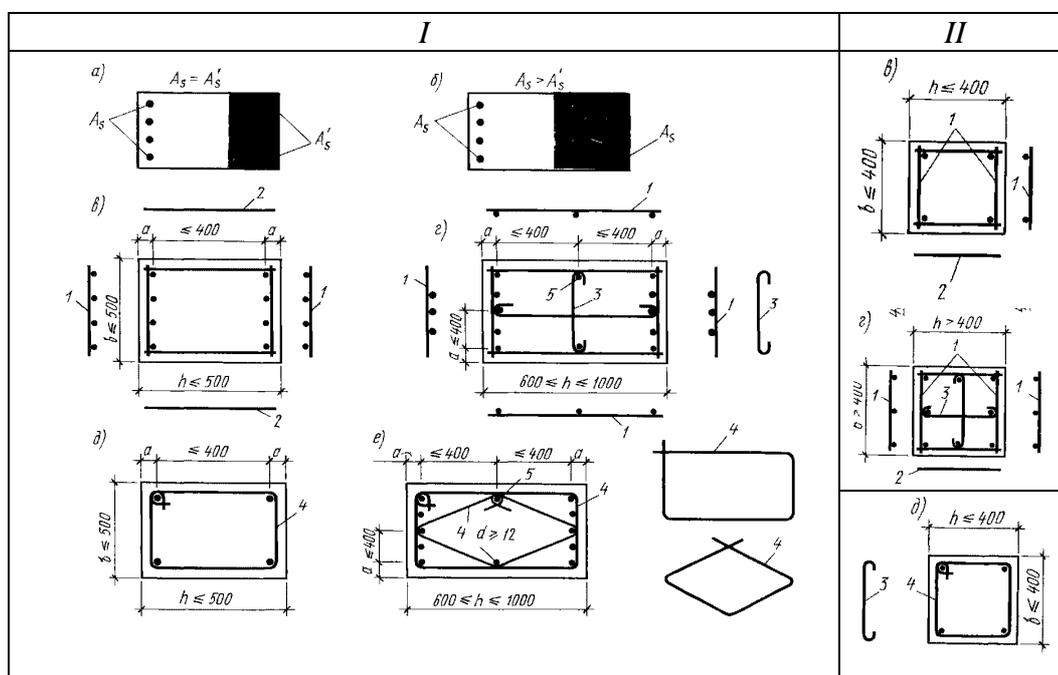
Основные конструктивные решения для поперечных сечений колонн.
